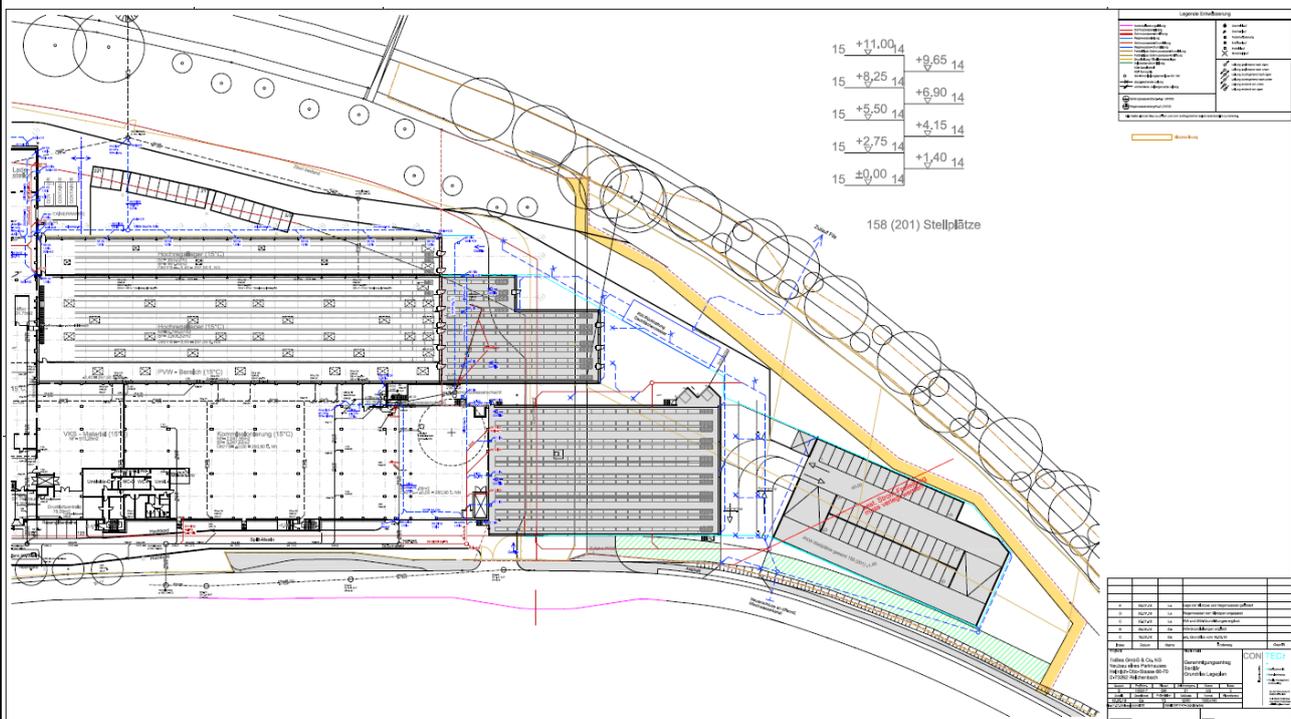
Entwässerungskonzeption Lageplan Stand 09.07.18 (INGENIEURBÜRO CON TEC GMBH)
